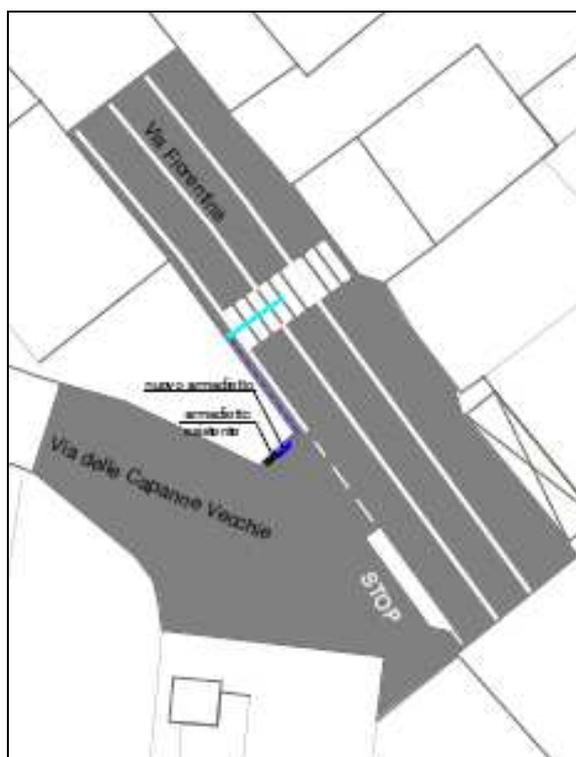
Stato di Progetto Via Fiorentina int. Via Capanne Vecchie - Planimetria
